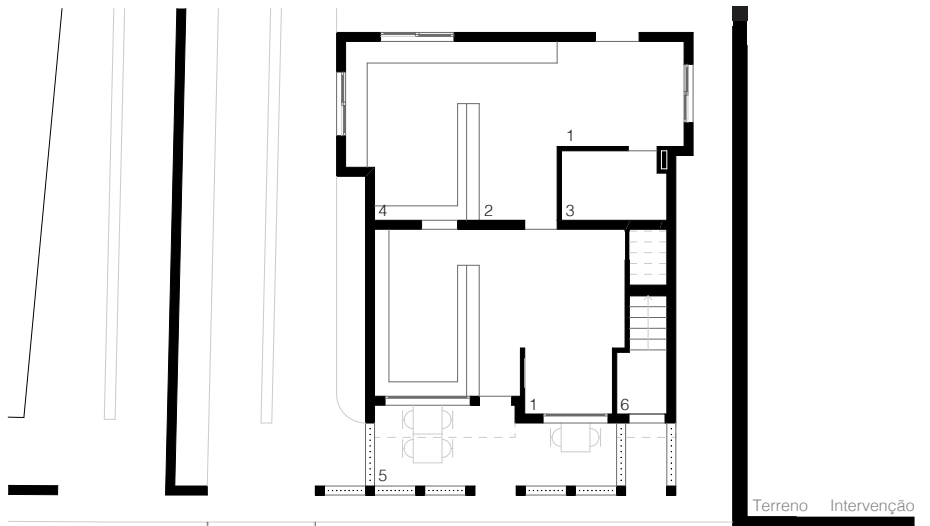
Bloco de apartamentos 'BONJOUR TRISTESSE', Álvaro Siza. Restaurante em posição central (gaveto) anunciada por um pilar estrutural e coberto.
